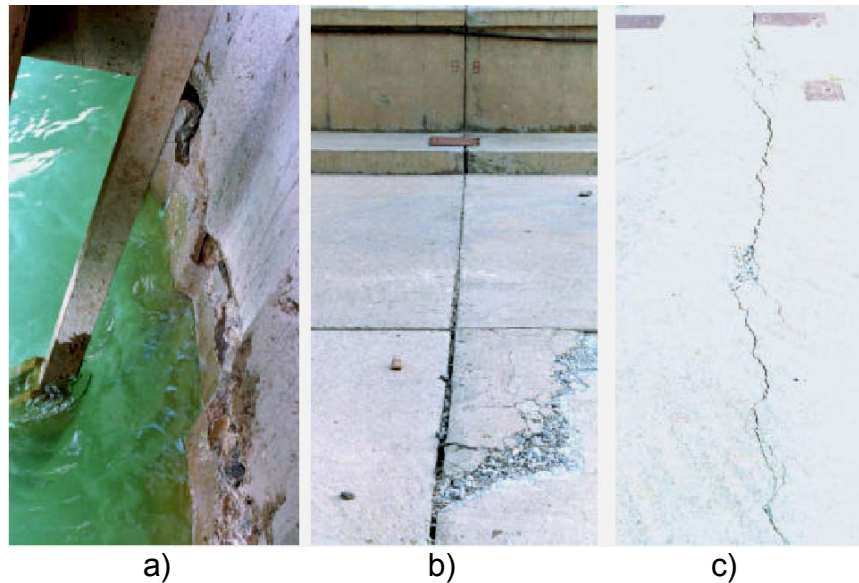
Fissuras na barragem de Seif Rud após o sismo de Manjil em 1990 [Wielan, 2002]: a) zona da margem esquerda de montante, b) pavimento do coroamento, c) pavimento do coroamento
